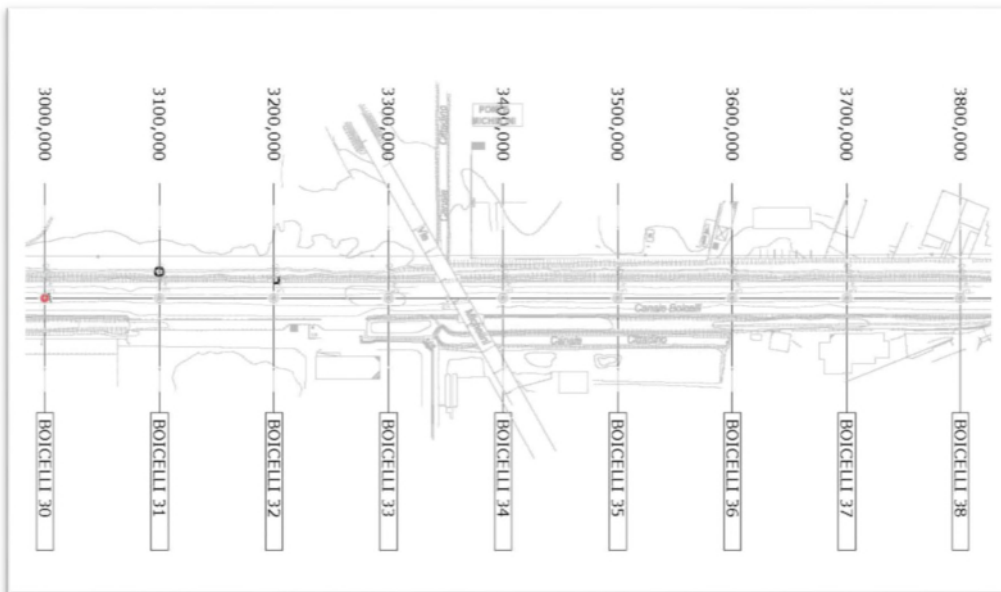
Estratto All. B.1 "Canale Boicelli – Planimetria con ubicazione delle sezioni"
